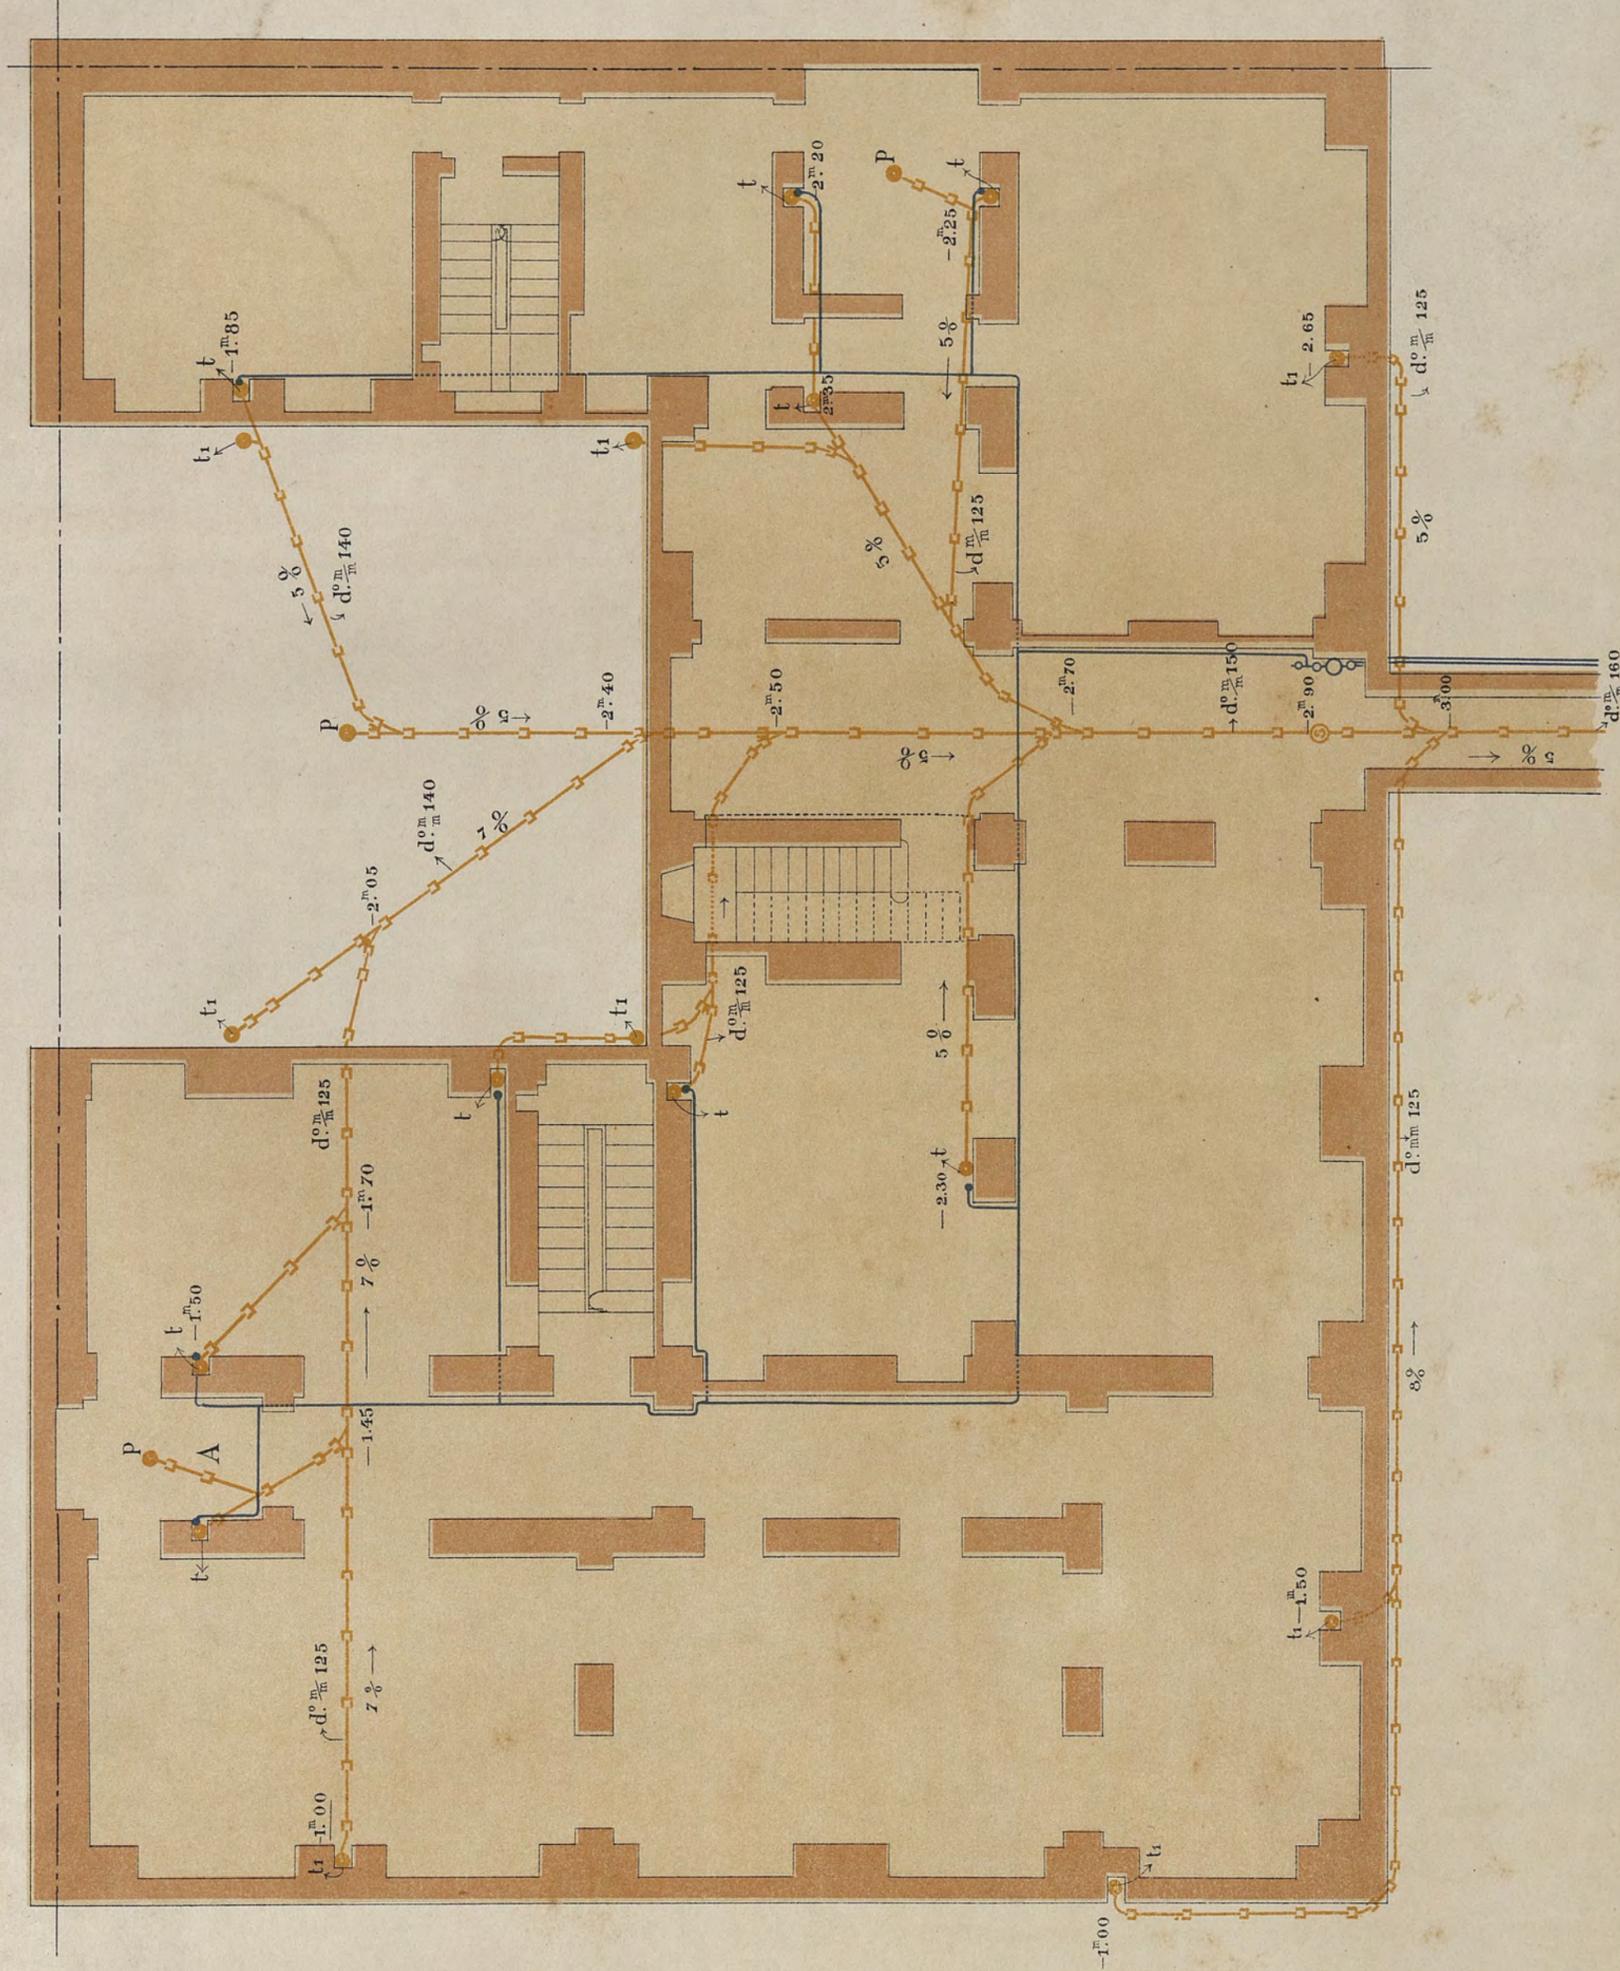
La pianta del 3.^o piano coll'ordinamento degli apparecchi e dei tubi
